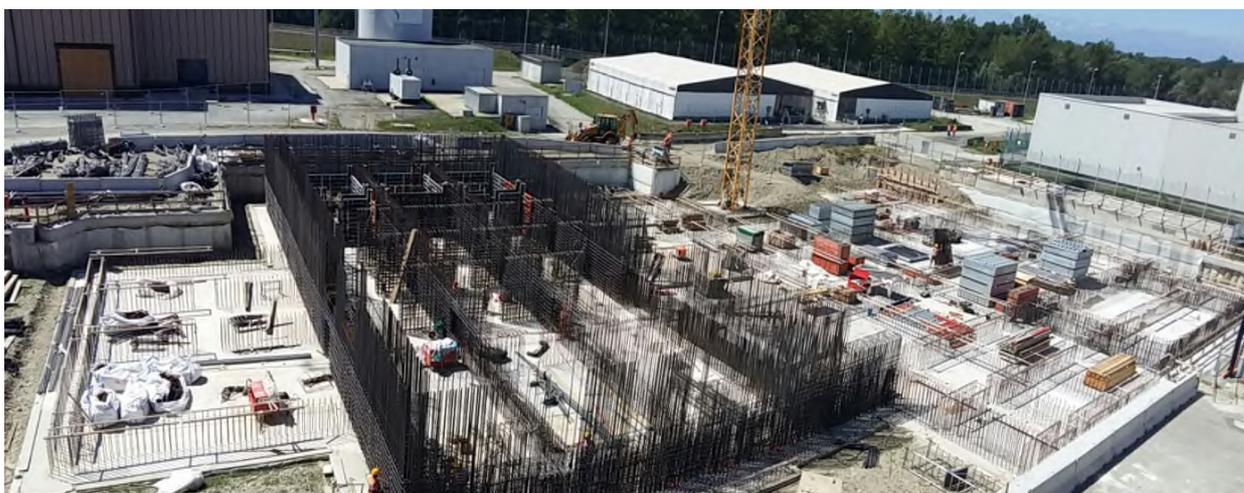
Vista d'insieme armatura delle pareti del deposito D3
